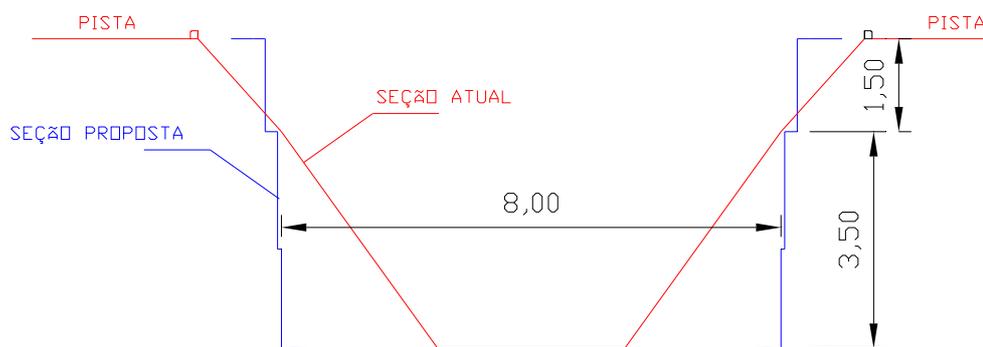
Ilustração da seção anterior à obra e seção proposta para o canal do córrego do Cubatão (unidades em metro) (PMF. 2006).
